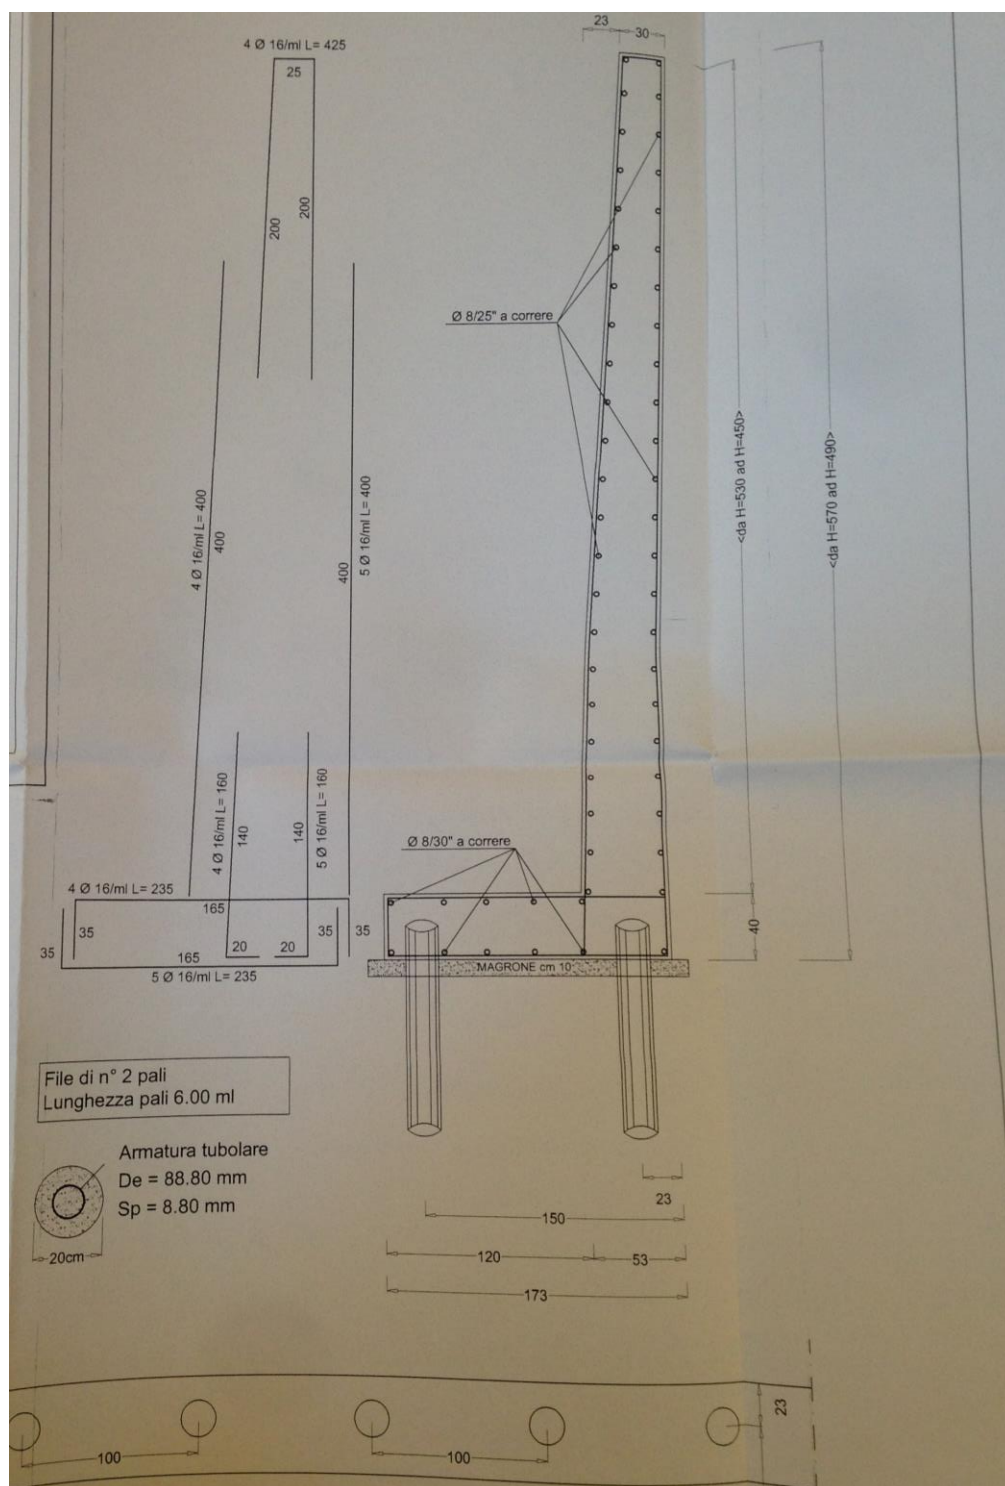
Sezione muro in c.a. – Estratto Pratica Sismica N. 373/2009
